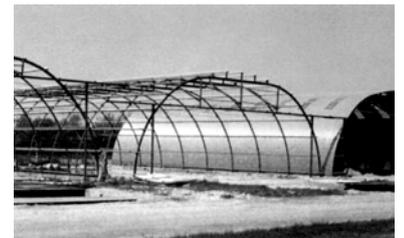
Montage der Rundbogenhalle Omega. Nach Errichtung der Konstruktion erfolgt die Verkleidung mit der Wellblechfassade. *Quelle: Frisomat.
